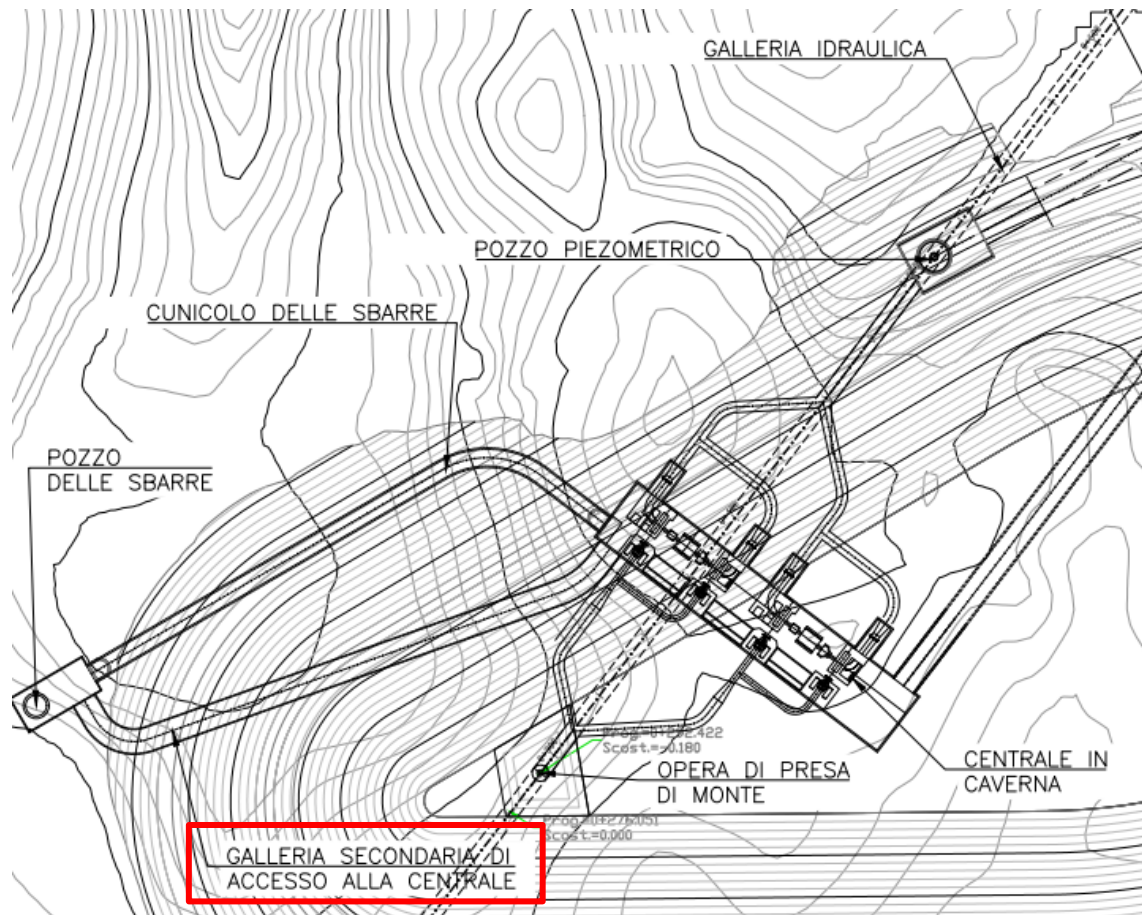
Planimetria con indicazione (riquadro rosso) della galleria d'accesso alla volta della centrale in caverna
